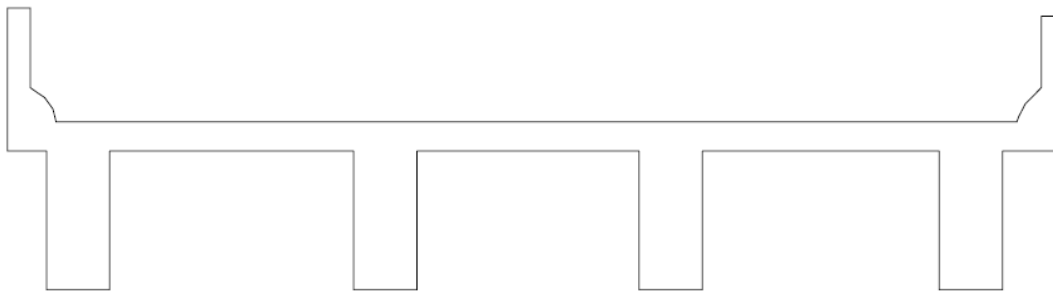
Sección transversal de puente con vigas T de concreto reforzado colado *in situ* (AASHTO, 2007)
